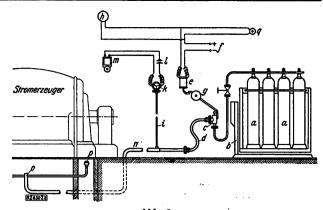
Kohlensäuregas-Feuerlöschanlage für Stromerzeuger
